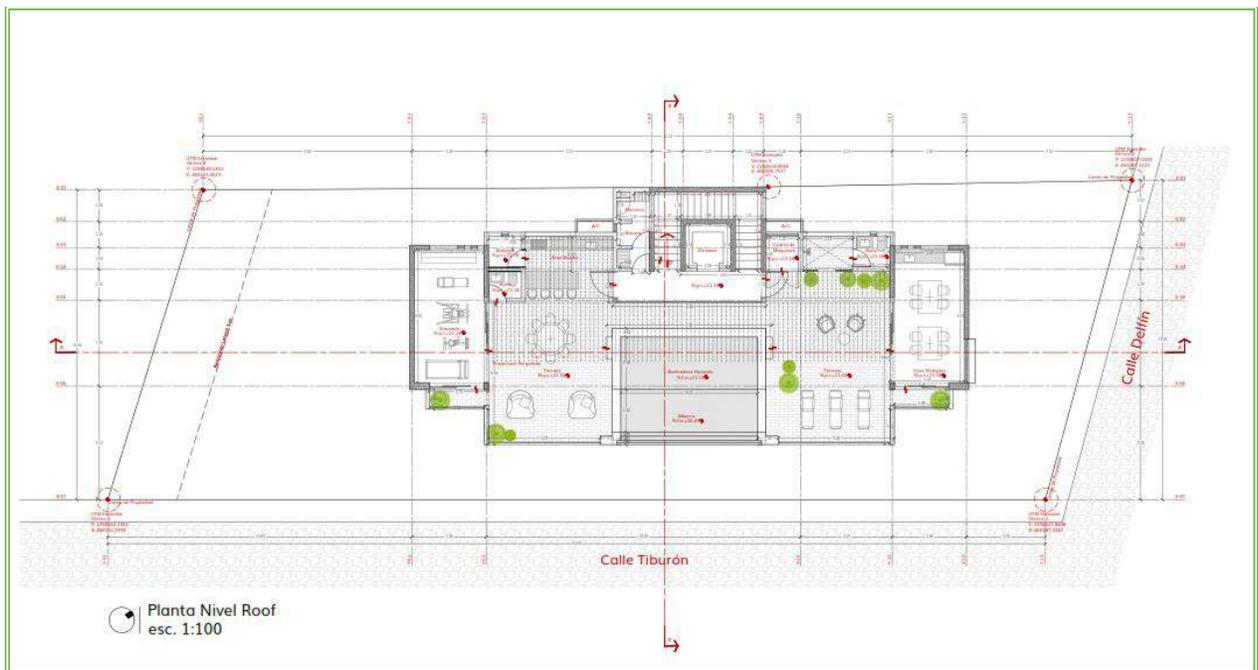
Detalle del diagrama del polígono de la planta azotea (Roof top)
